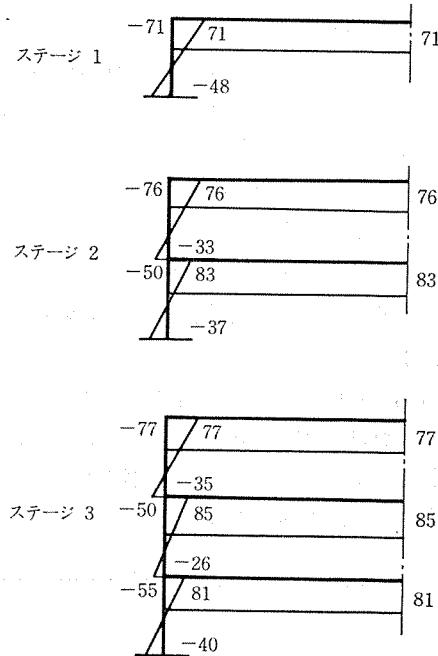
施工段階別、プレストレス導入にともなう不静定応力—一体式(単位:t·m)
